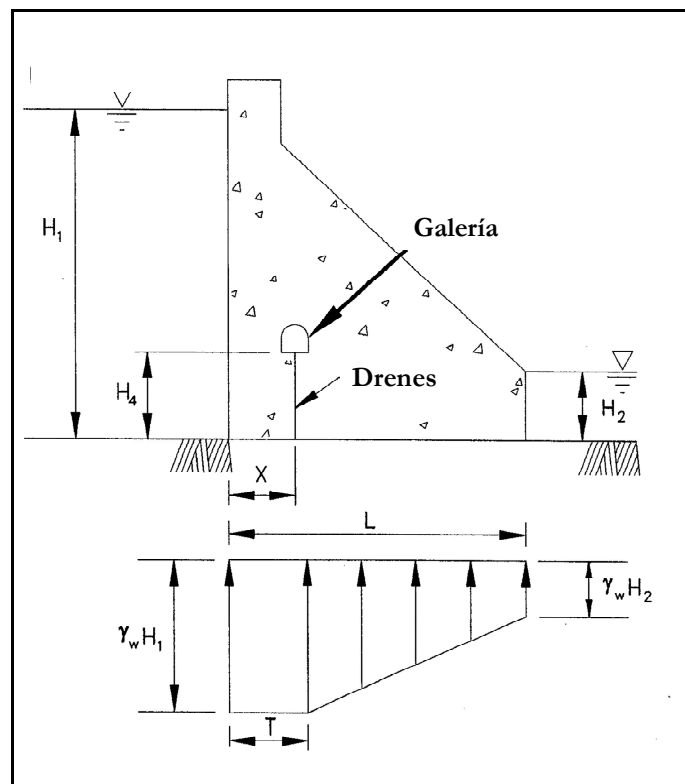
Ley de subpresiones. Caso estático, con pantalla de drenaje. Con grieta bajo del pie de aguas arriba más allá del plano de drenes. (Fuente: USACE [136]).
